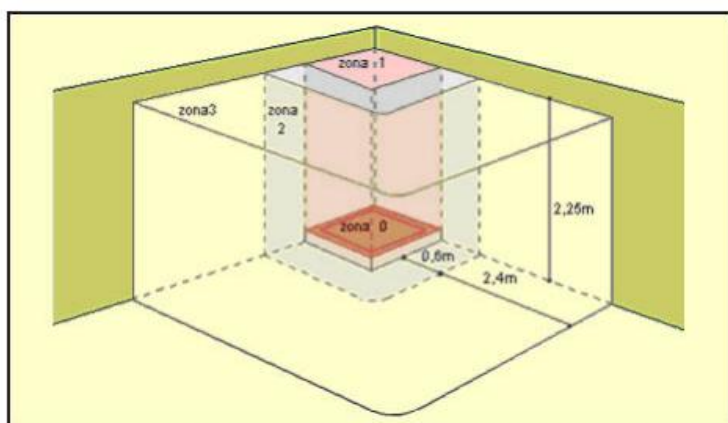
Suddivisione in zone, in funzione della pericolosità, nei locali bagno e doccia
